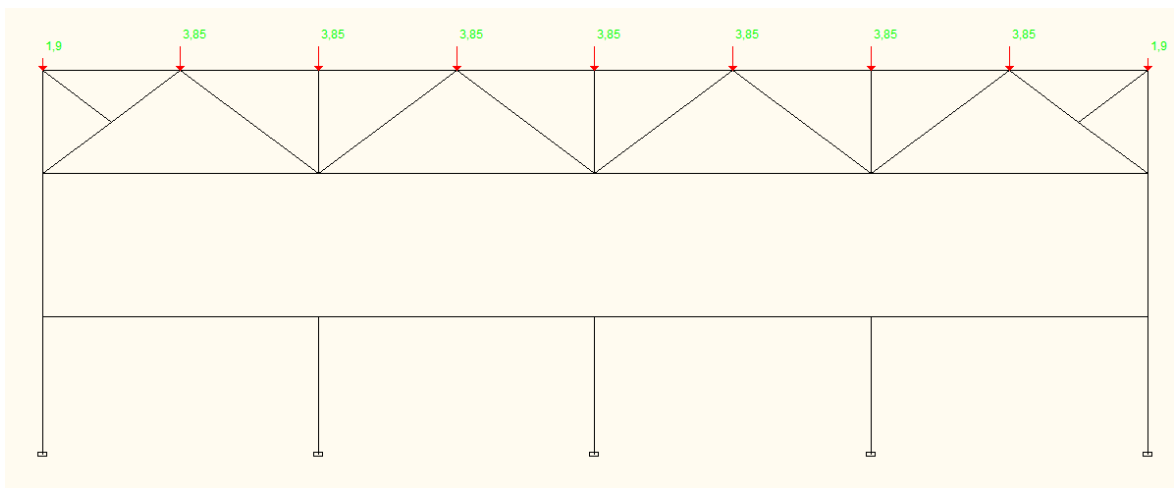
Схема приложения нагрузки на покрытие рамы
